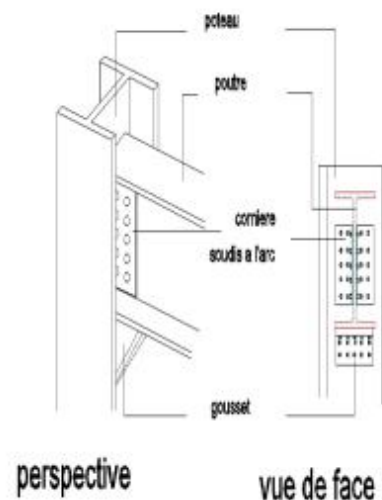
Assemblage d'une poutre en I et d'un poteau en H.
